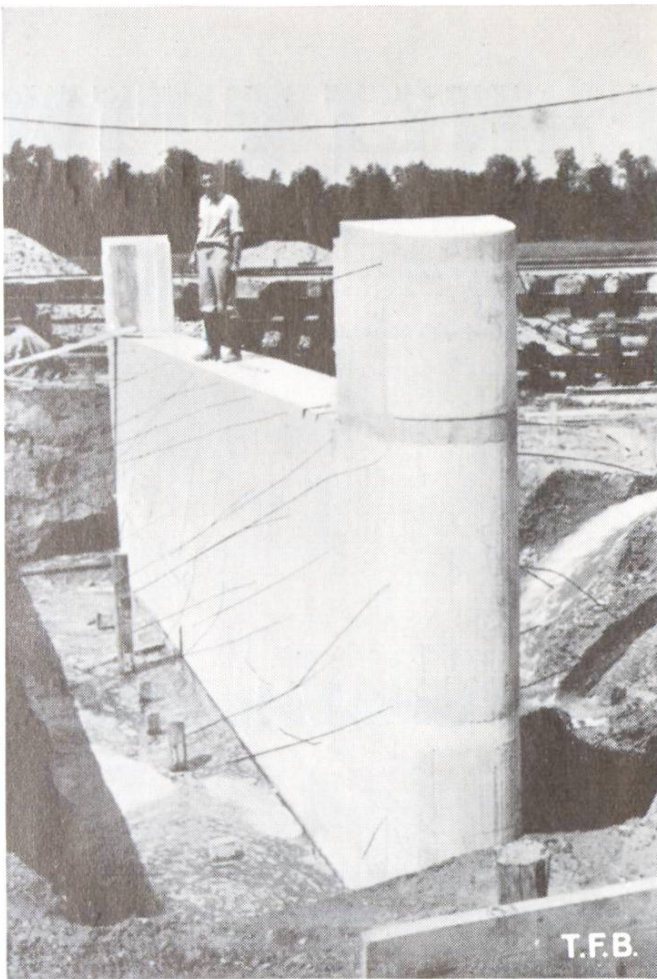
Wandartig schlanker Vorlandpfeiler gegründet auf einer Betonpfahl-Fundation
